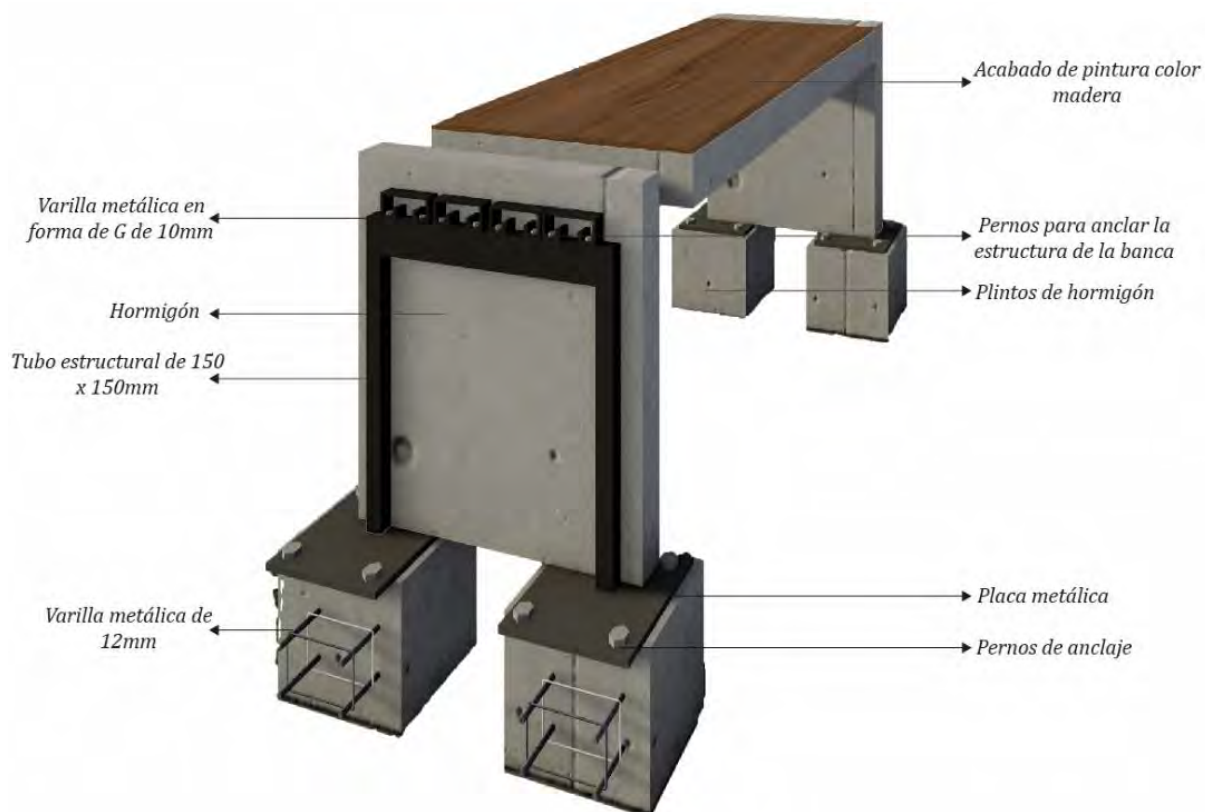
Detalle constructivo de cómo van a ir las sillas que forman las áreas de descanso dentro de la plaza. Fuente: Autora.
